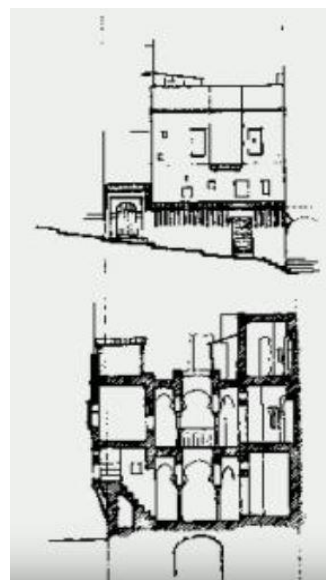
sección y alzado de la Kasbah de Argel-Marruecos.
